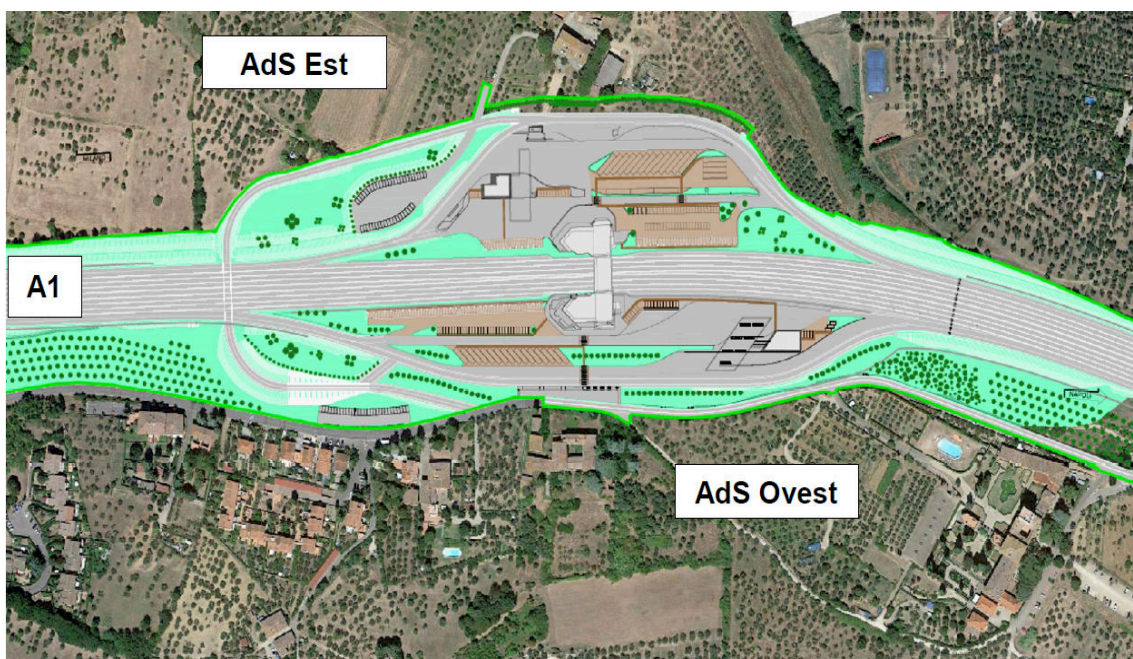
Planimetria progetto definitivo approvato (Fonte: lista di controllo)
